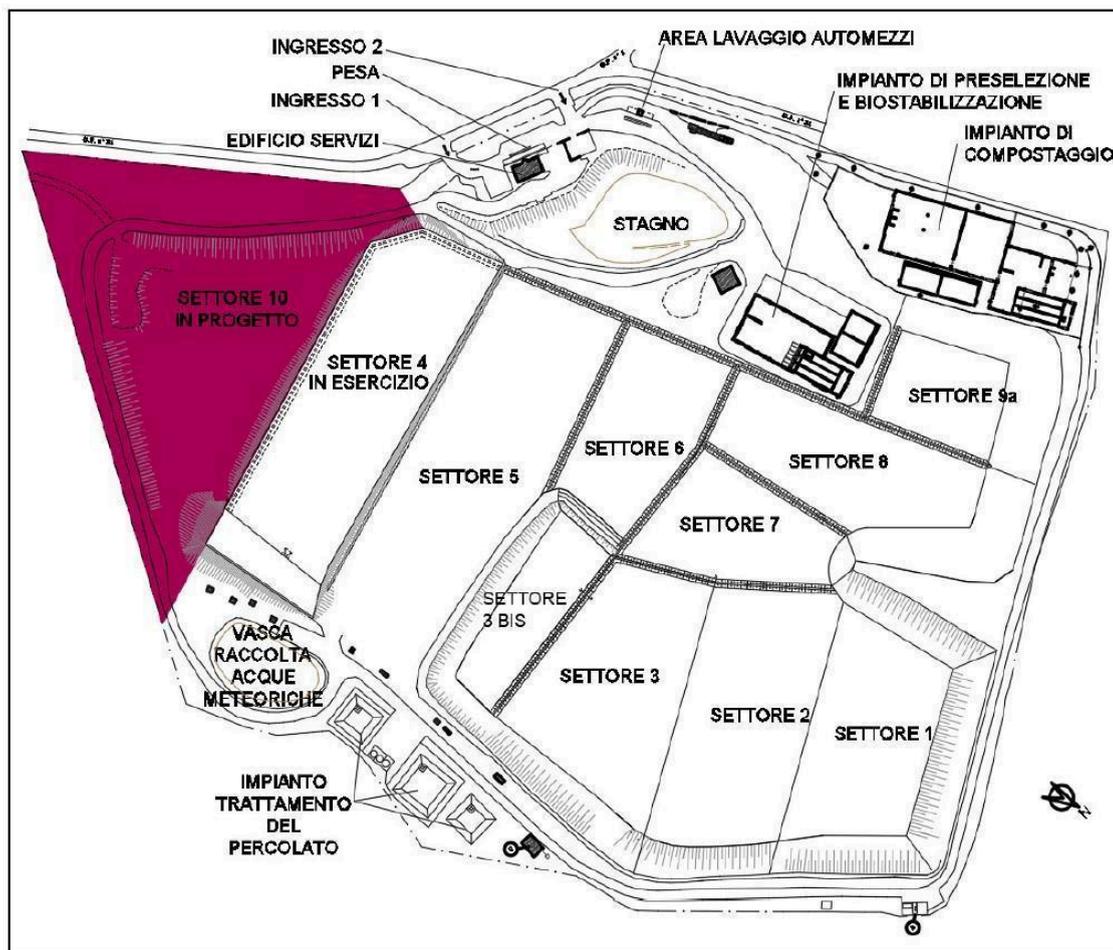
Planimetria generale impianto con indicati singoli settori e area destinata alla realizzazione del Modulo 10
